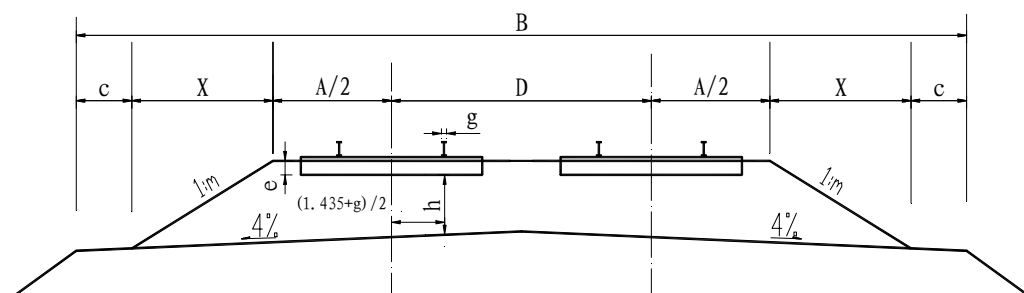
双线铁路直线地段标准横断面示意图
